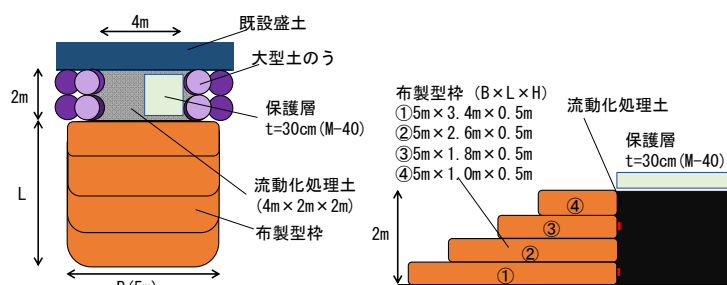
試験盛土の概要 (左: 上面図、右: 断面図)
